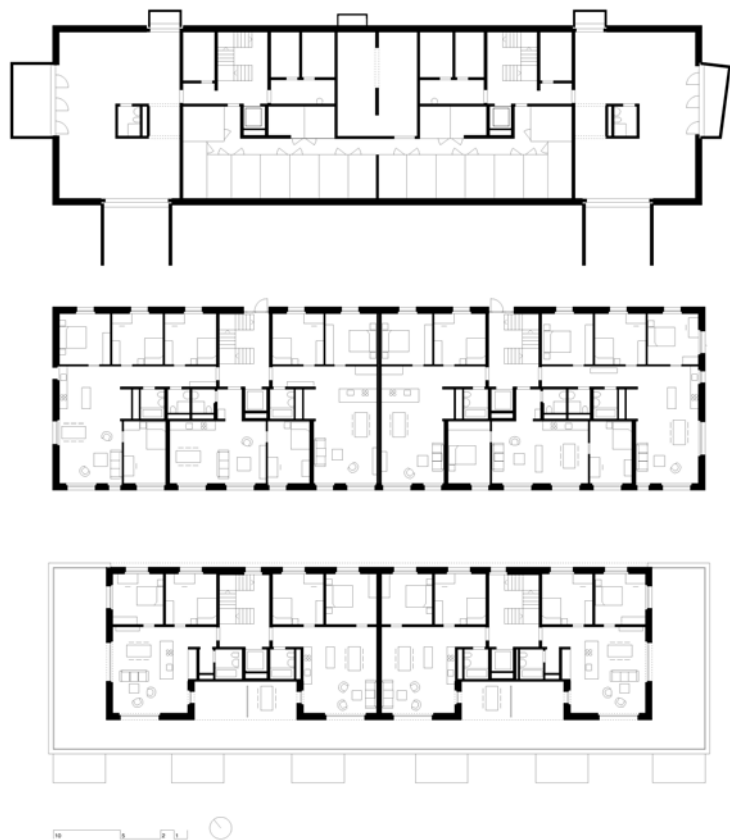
Grundrisse UG, EG, Attika Haus A
